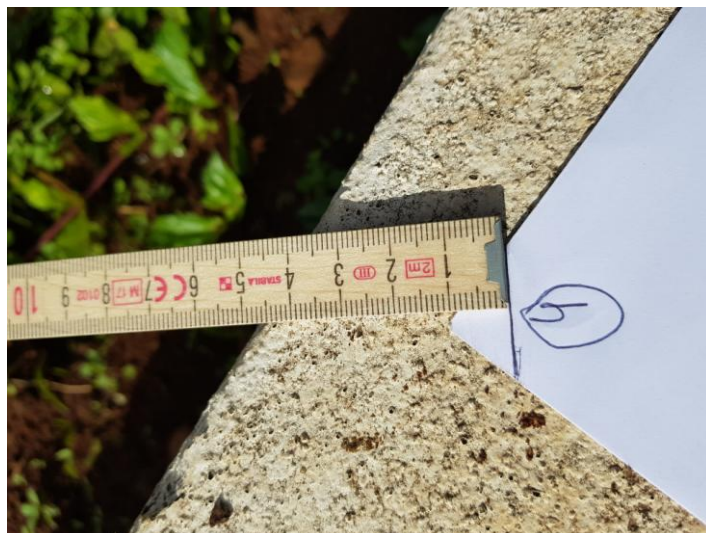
medição profundidade fissura 4 (11 mm)
